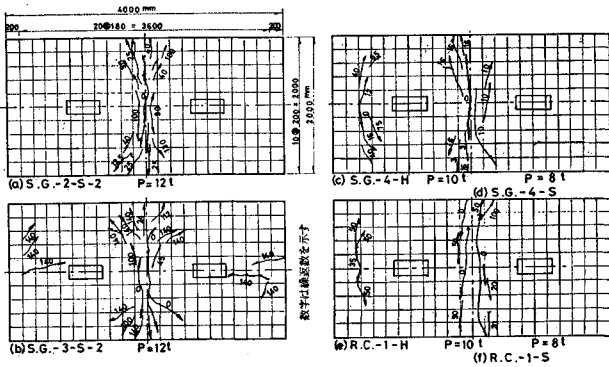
繰返試験におけるコンクリート表面のひびわれ状況
